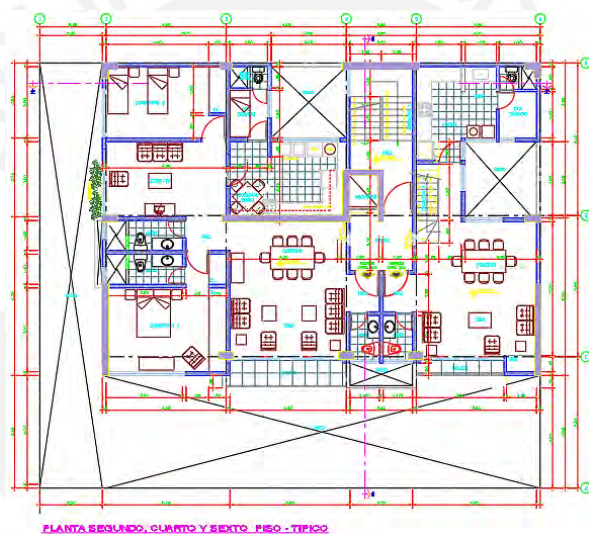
Planta arquitectónica típica de los pisos pares, salvo el octavo.
